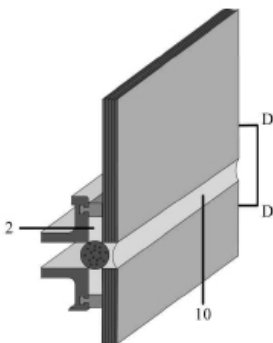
A: Detail dwarsverbinding. Voorbeelden van structurele beglazingsontwerpen: 2-zijdigontwerp (ter plaatse aangebracht).
